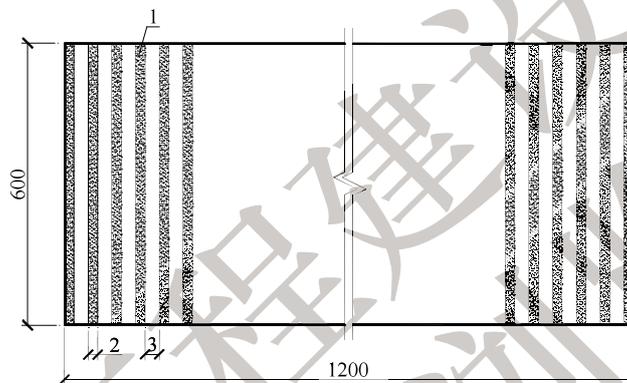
条粘法示意（尺寸单位：mm）
